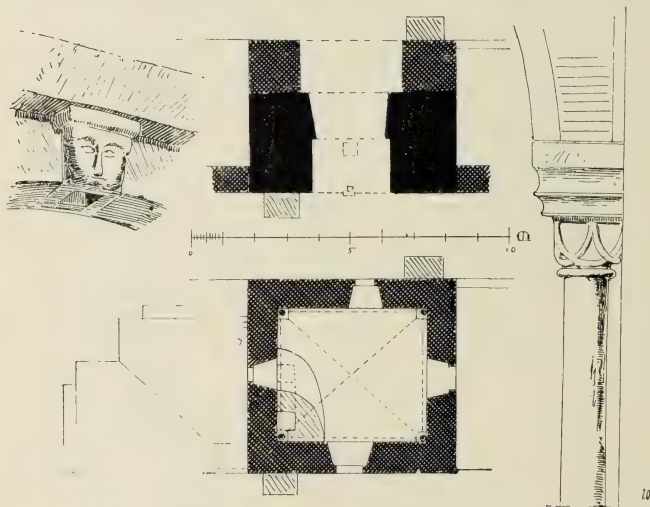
Rheinbach. Thorturm der Burg, Grundrisse und Einzelheiten.
